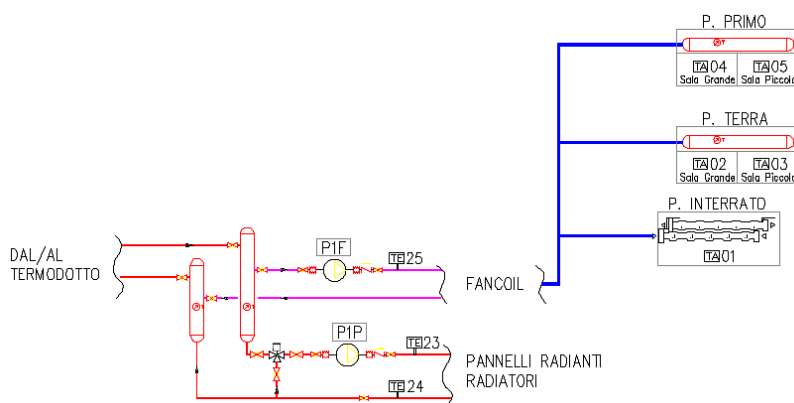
Stralcio schema funzionale – Sottocentrale e circuito Fan coil e pannelli a pavimento.
